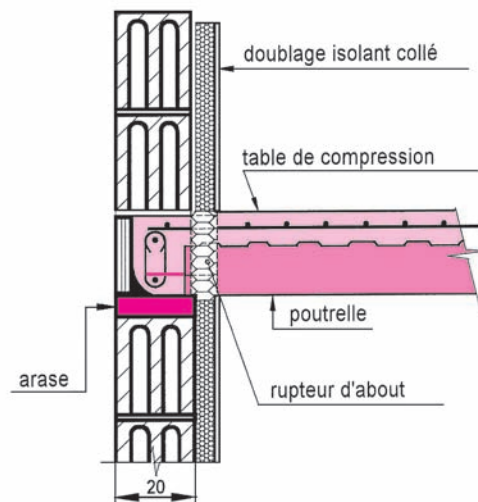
Rupteur thermique d'about entre les poutrelles
